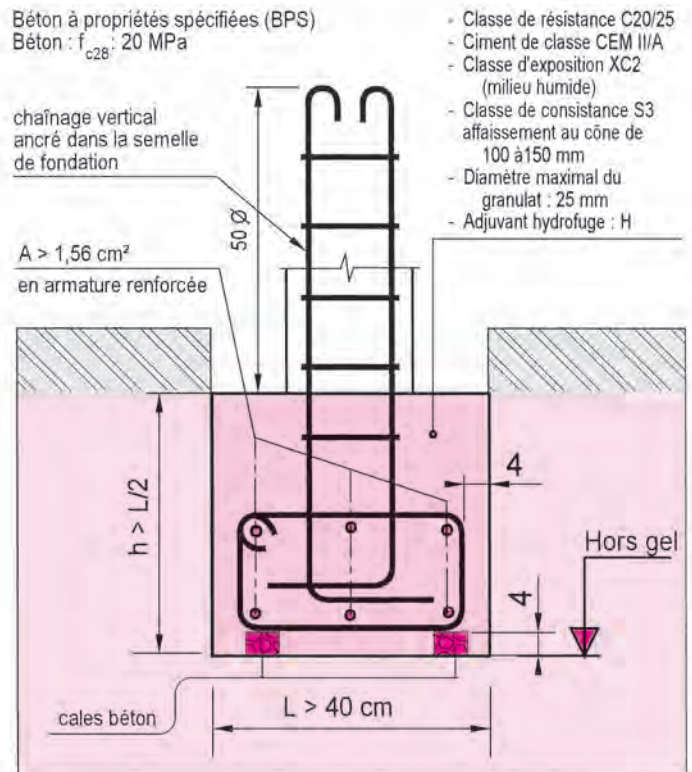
Semelle continue en béton armé coulée pleine masse
